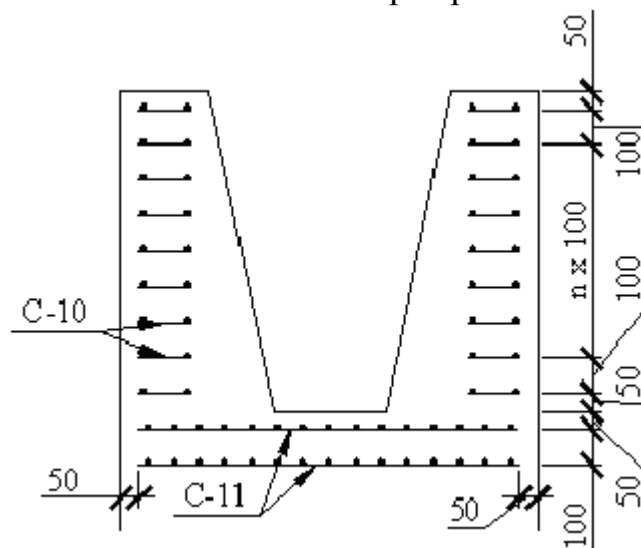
Схема армирования подколонника сетками С-10 и С-11
